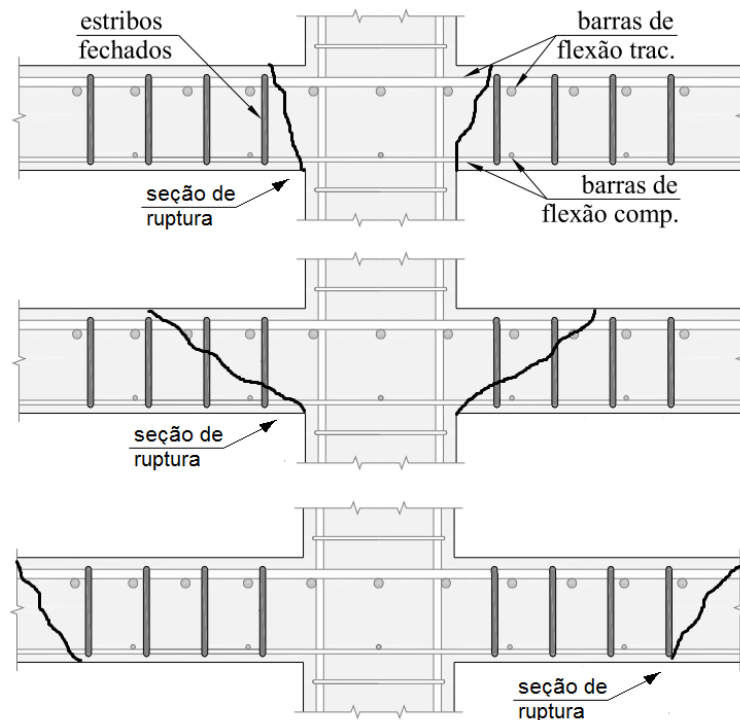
Regiões de ruptura em lajes lisas com armadura de cisalhamento (adaptado de Ferreira, 2010)
